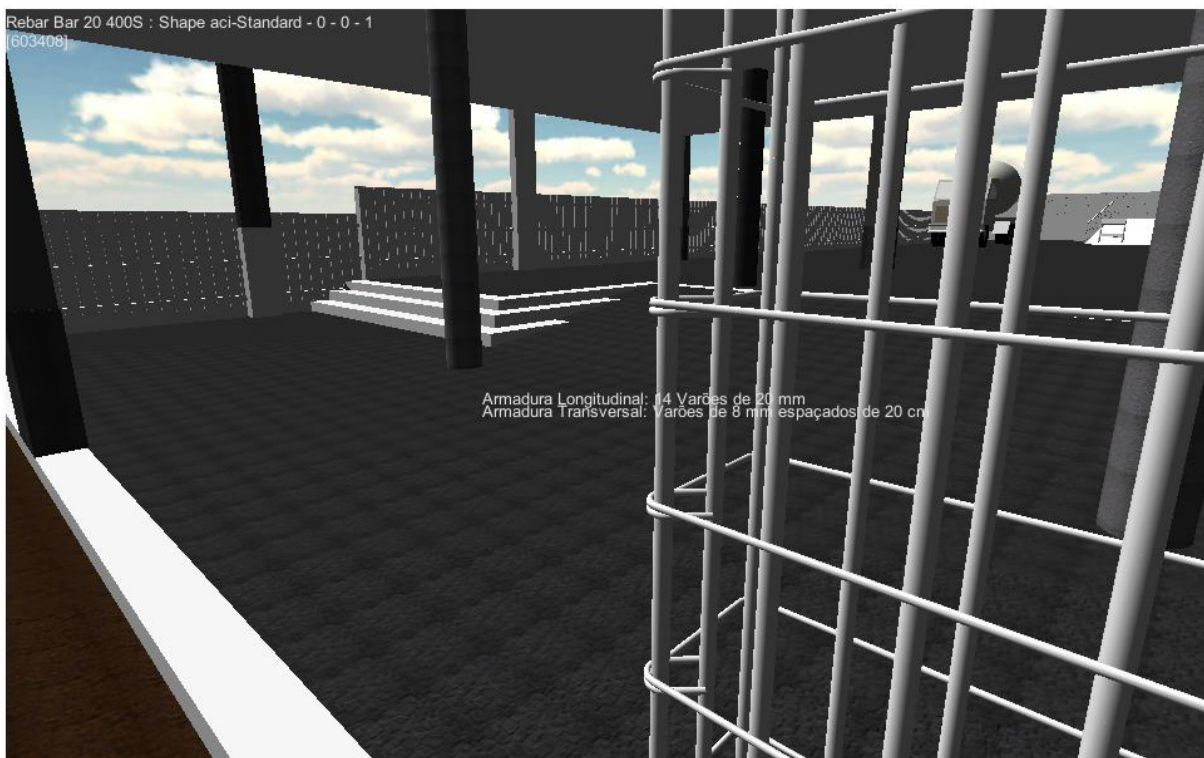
Armaduras de um pilar com pormenor da amarração e informação do diâmetro da armação
